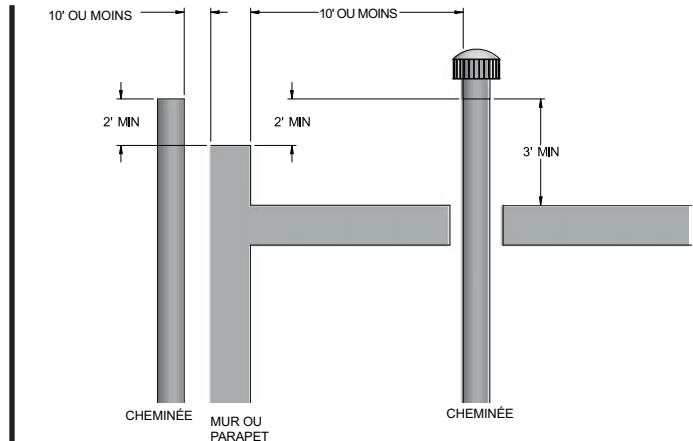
Terminaison de ventilation depuis un toit-terrasse - 10 pi. Ou moins du parapet
